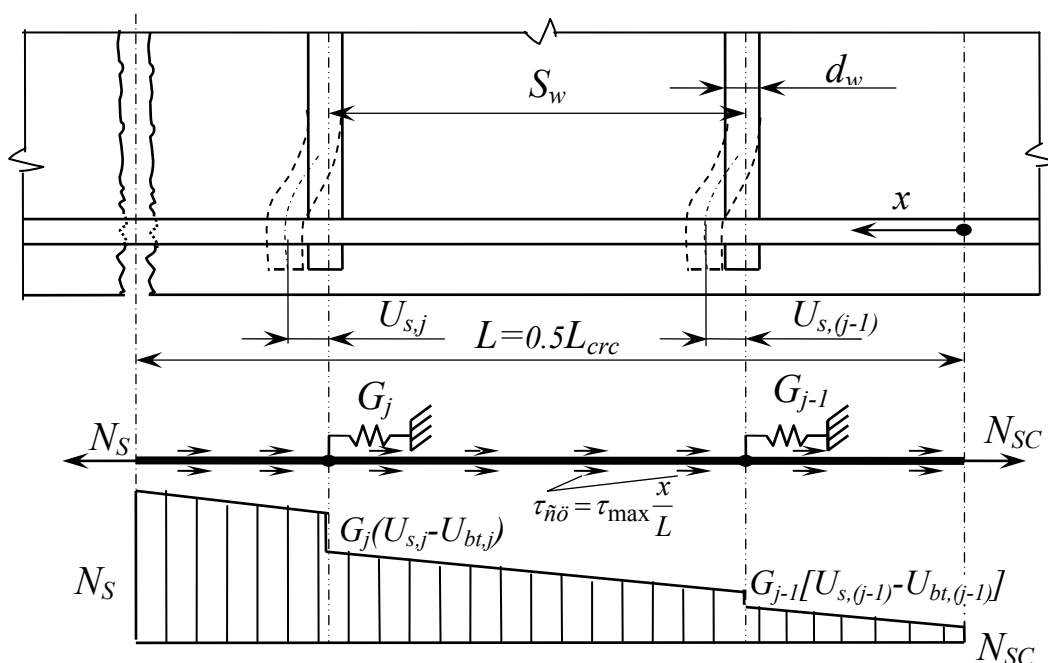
Расчетная схема продольной арматуры с поперечными связями
